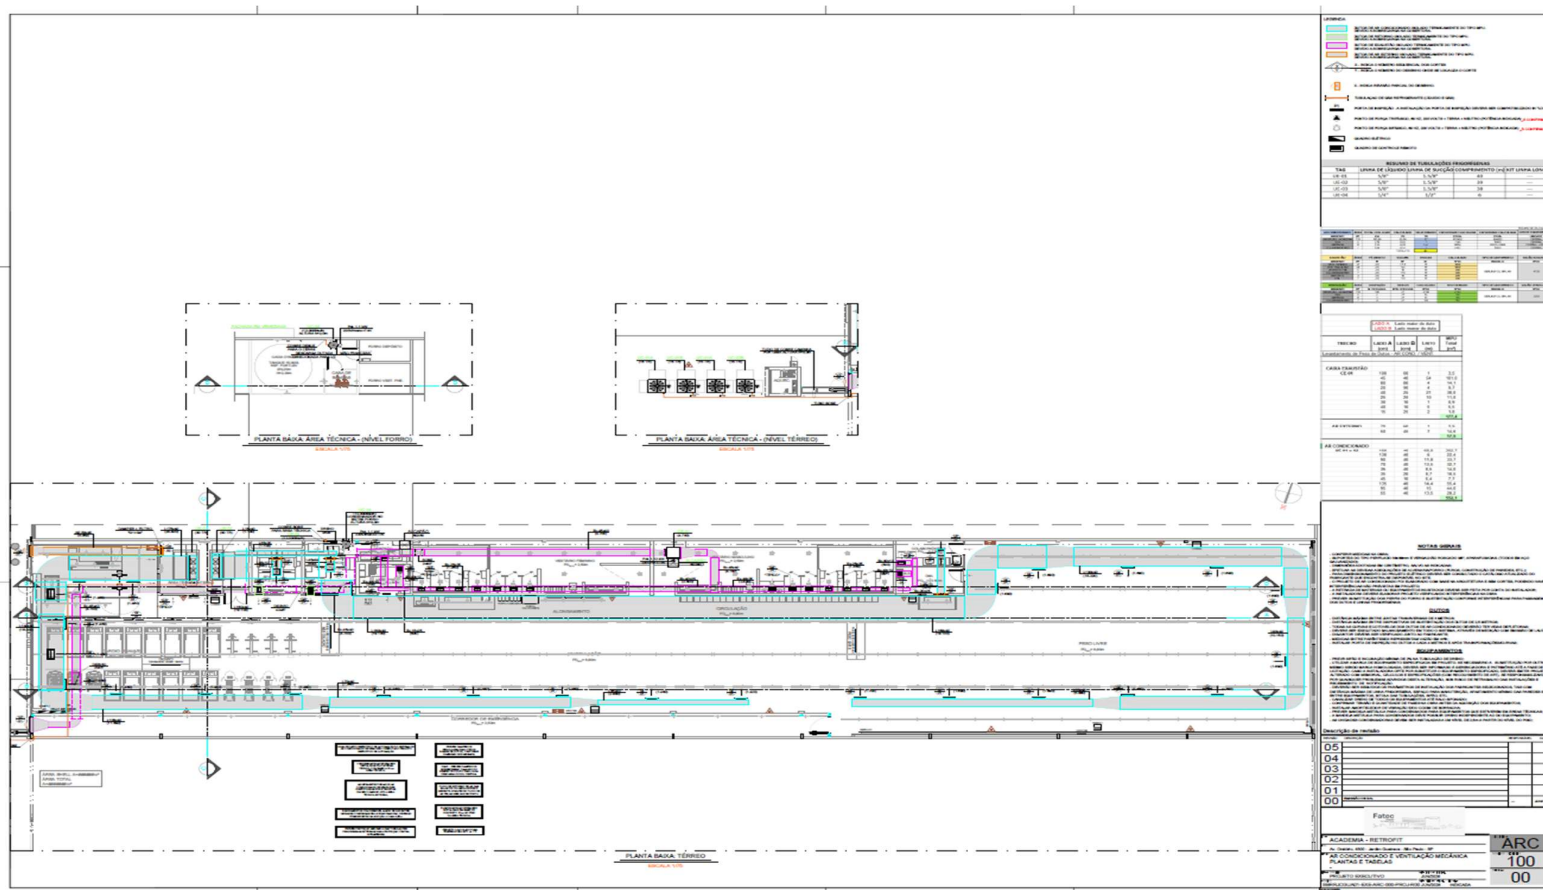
Planta baixa da academia contendo as Zonas térmicas
